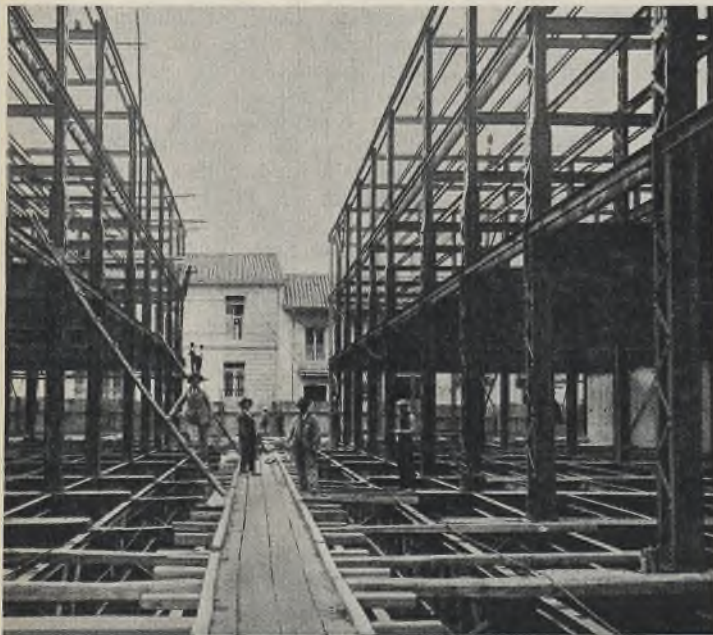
Straße mit Stahlkonstruktions-Unterbau.
